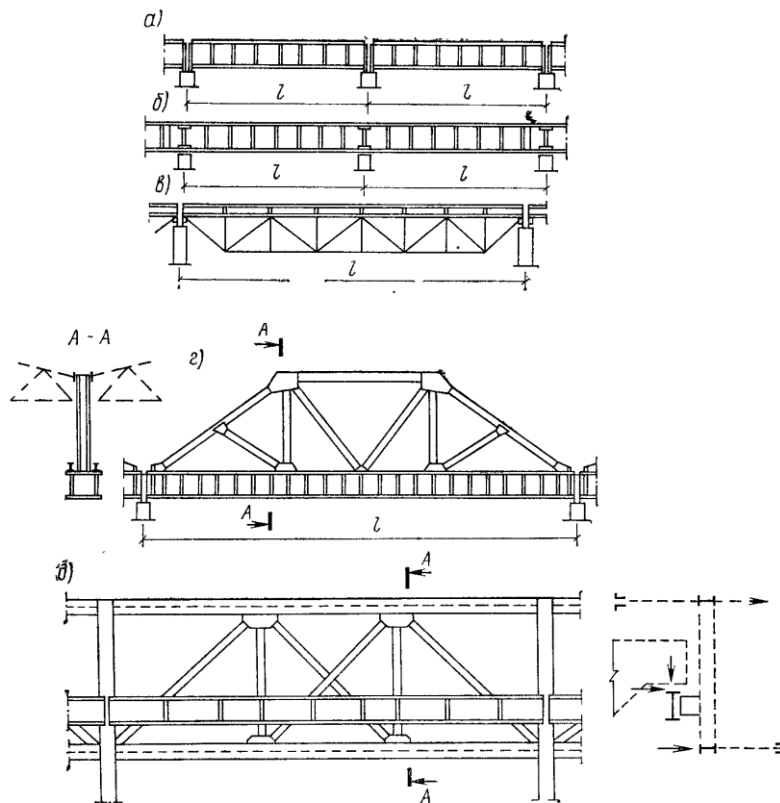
Типы подкрановых конструкций: а) разрезная балка; б) неразрезная балка; в) ферма; г) подкраново-подстропильная ферма; д) ферма с ездой по низу.
